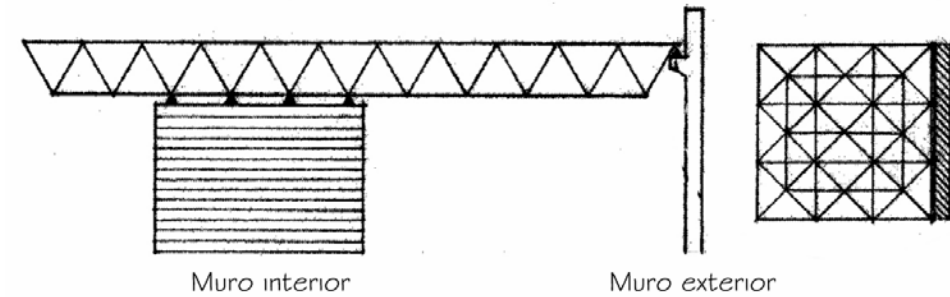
Un muro de concreto reforzado distribuye los puntos de soporte a lo largo de una línea.
